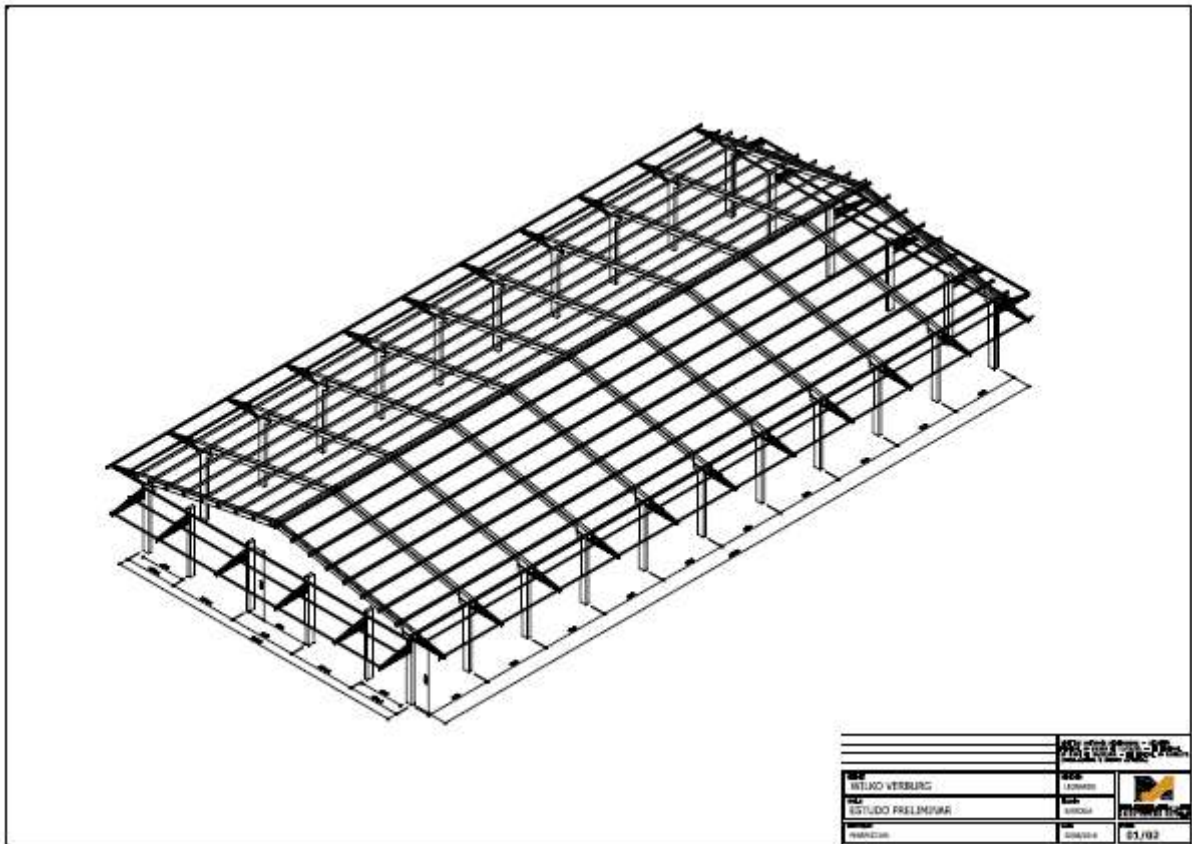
Modelo em 3D da construção do barracão pré-moldado
